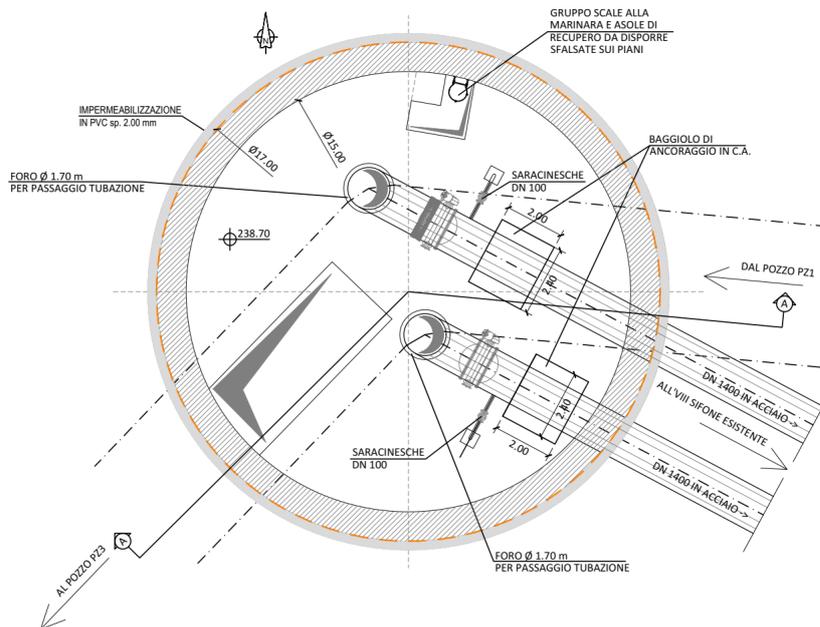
Rappresentazione in pianta del manufatto PZ2
